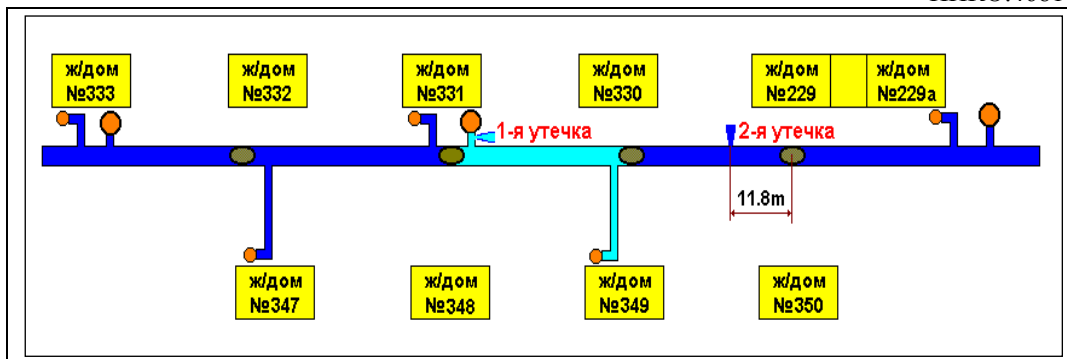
Схема участка водопроводной сети, где были выявлены две утечки
